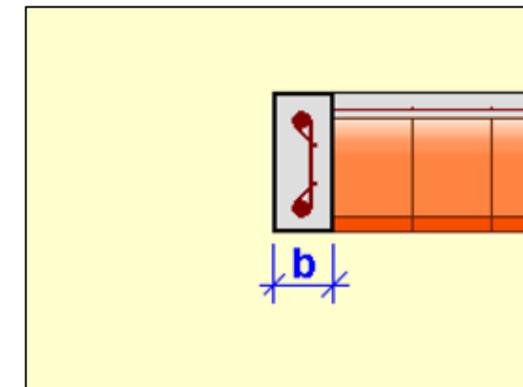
Sección tipo zuncho de borde. Fuente: CYPE
